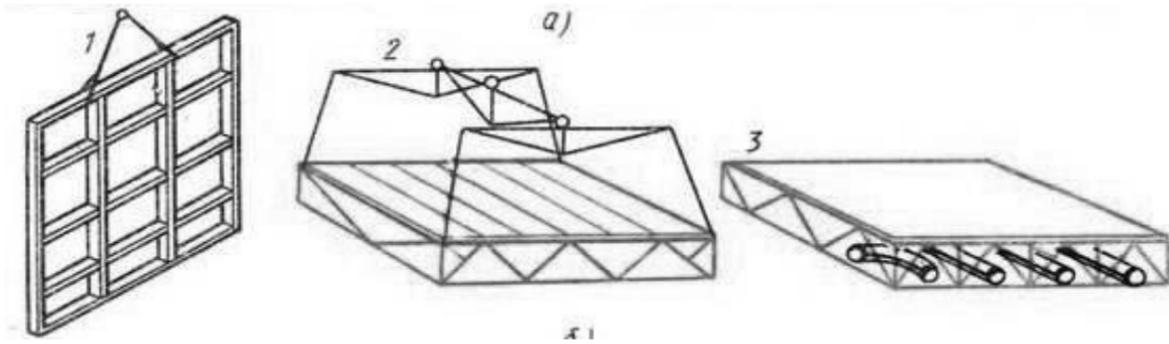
Монтажные операции с блоком перекрытия. Основные узлы компоновки перекрытия из отдельных прогонов приведены ниже. Для опирания прогонов применены подвески из листового материала. Крепление подвесок к ригелю выполняется на самосверлящих шурупах. Для обеспечения устойчивости прогонов из плоскости устанавливаются связи различных конструкций (рис. Е6, Е7, Е8).
